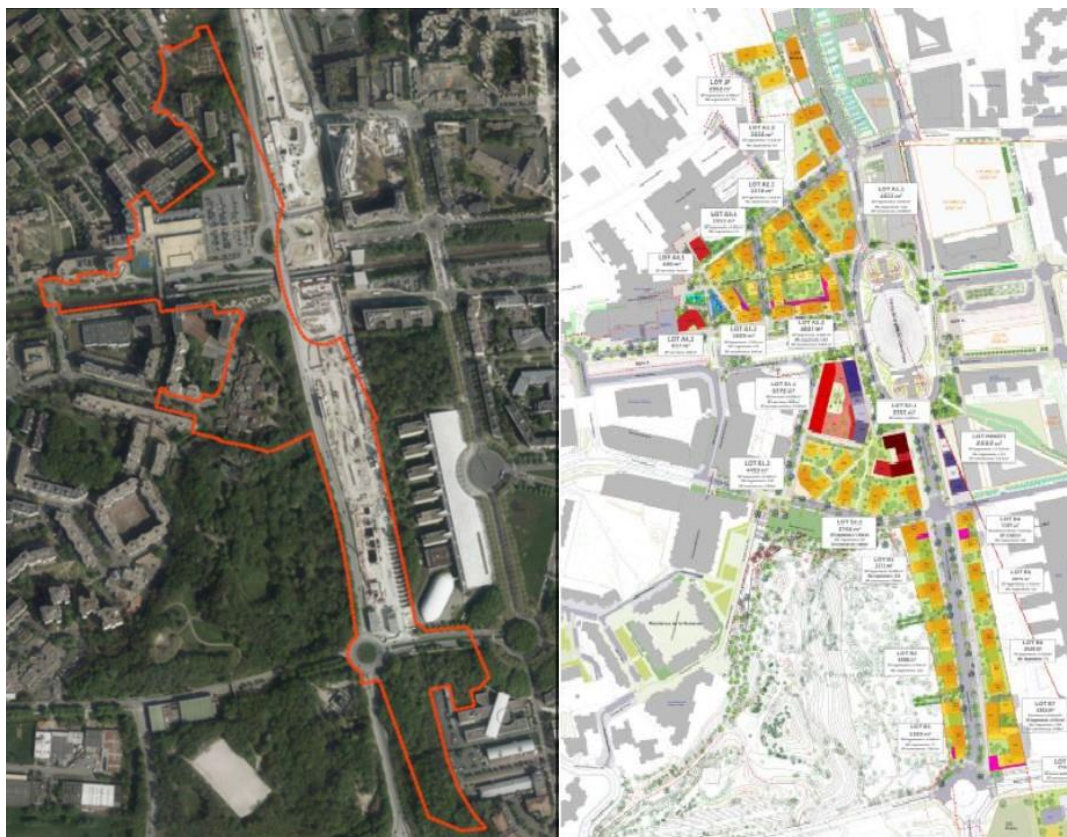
Plan de masse du projet de Zac (source : EpaMarne)
